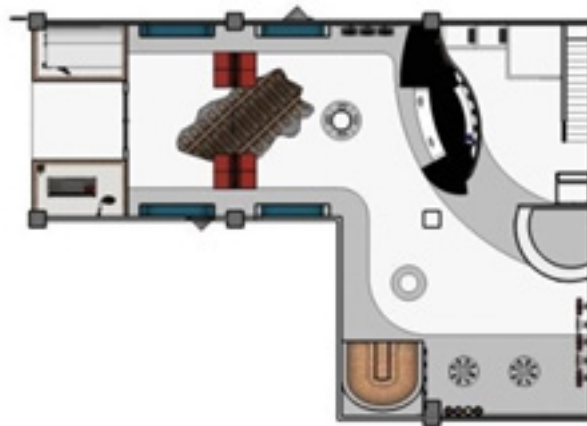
Planta baixa – layout interno. Fonte: Acervo pessoal.
